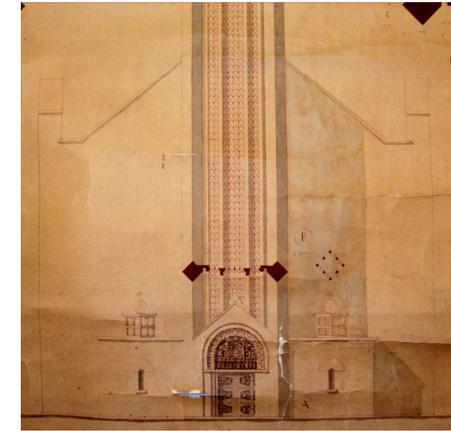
Desenho de trecho da fachada principal da Igreja.
